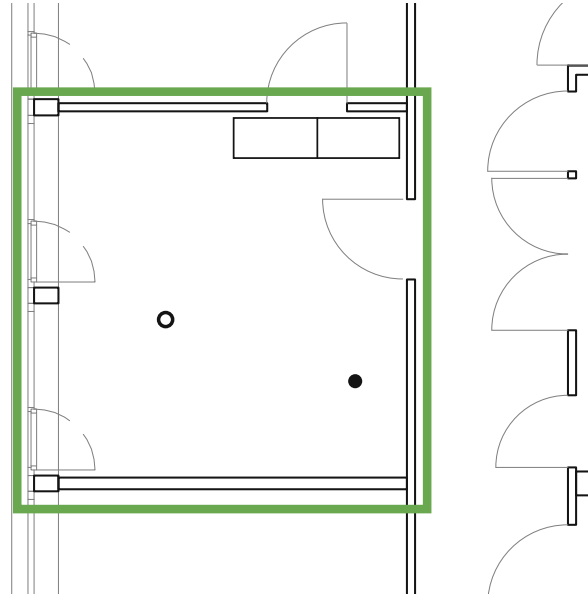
Grundriss Trakt OY, 1.OG
